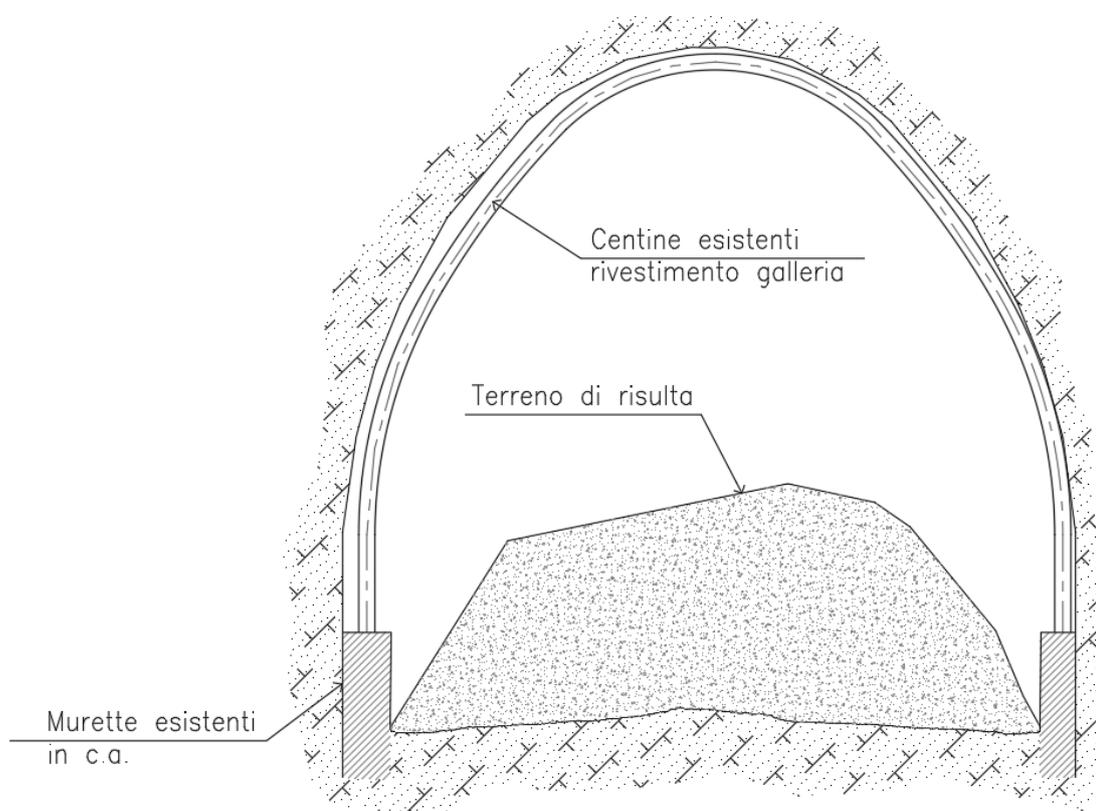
Sezione trasversale stato di fatto Galleria Impianti
